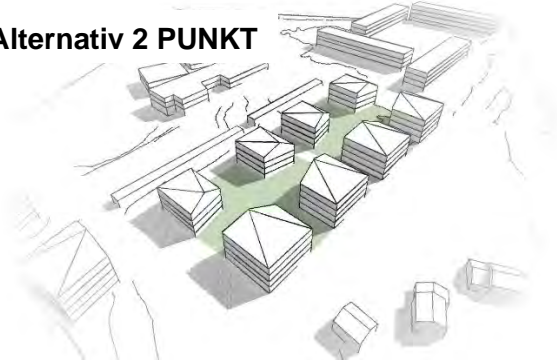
Preliminära utkastsbilder om bostadsbyggnader som planeras på området (Källa: Borgå stad)
